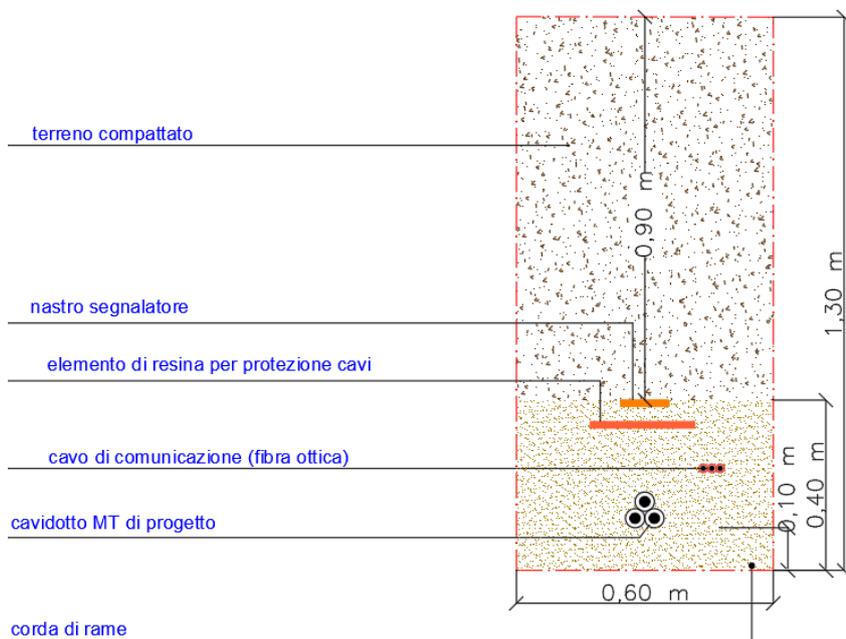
Sezione Cavidotto singola terna di cavi su Terreno
